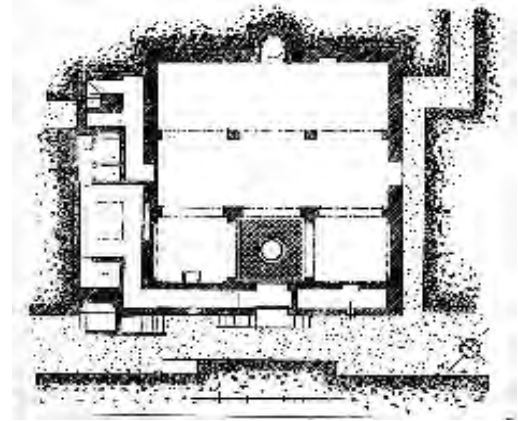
مسقط أفقي لمسجد الشرابيين بفاس القديمة.
